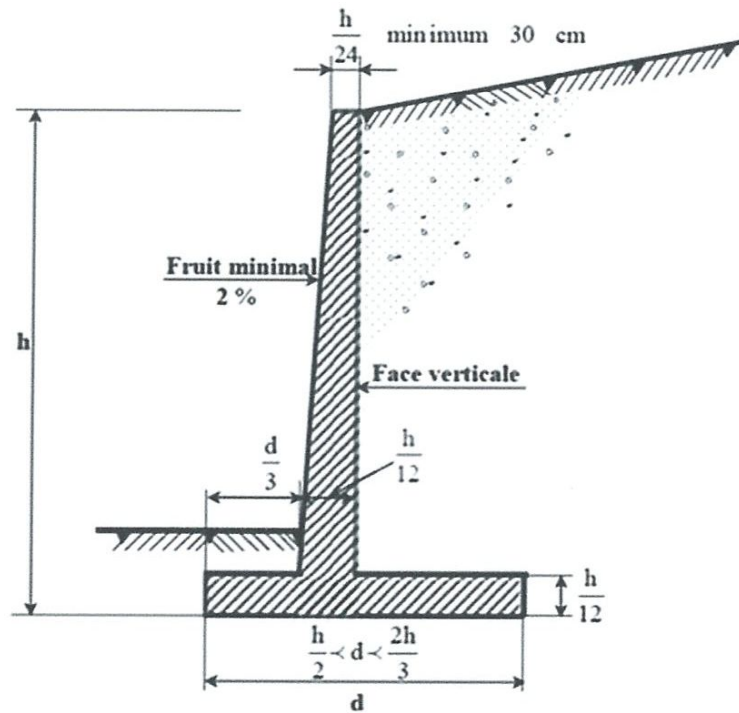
Dimensions usuelles d'un mur de soutènement en béton armé.
